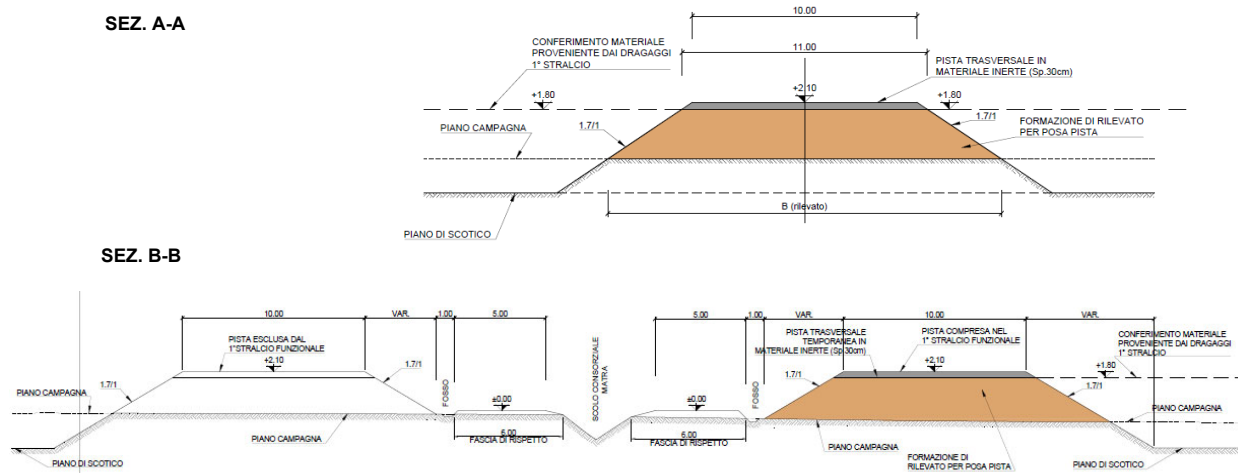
Sezioni tipo: A-A (sopra) e B-B (sotto)
